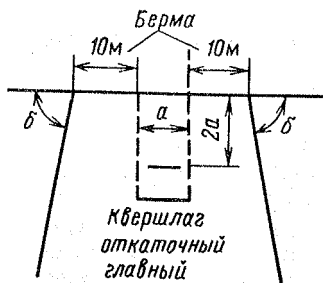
Схема построения охраняемой площади для капитальной горной выработки
